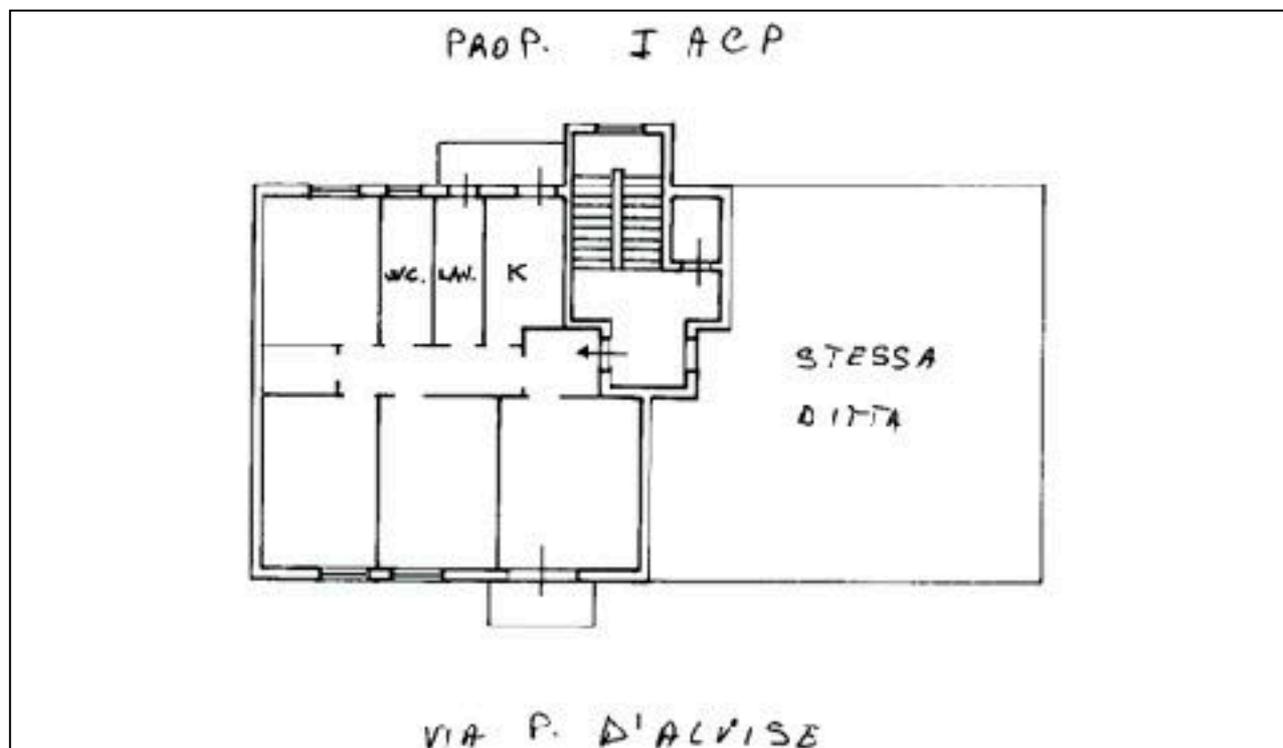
Planimetria catastale scheda prot. 1383 del 24.08.1984 ultima in atti
